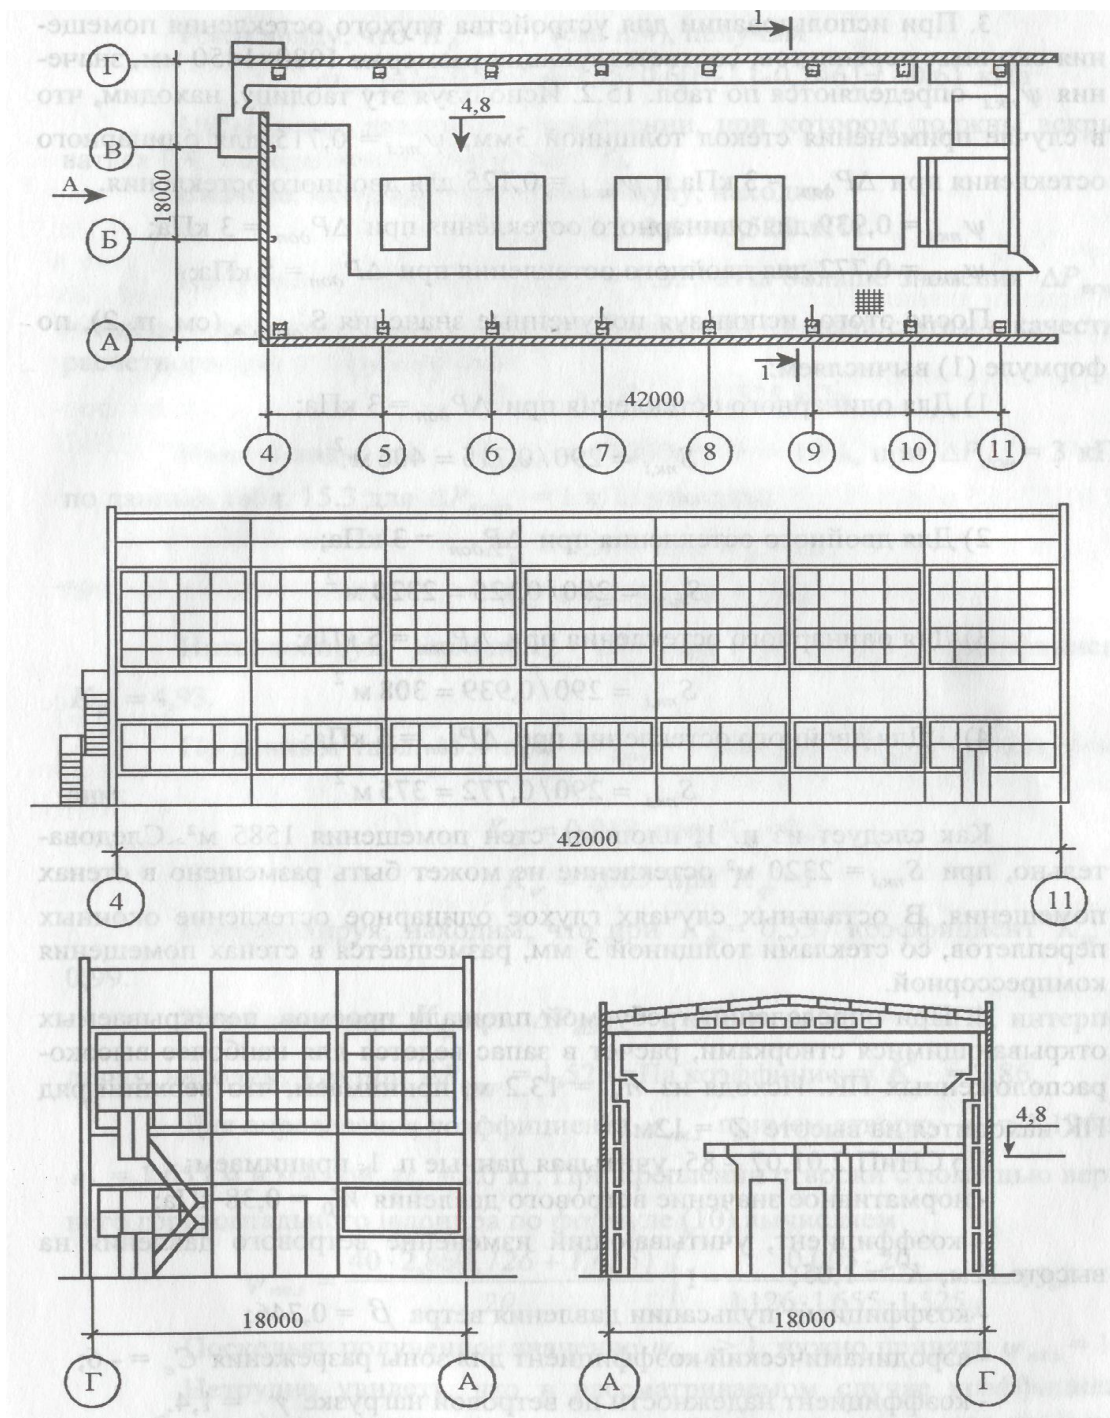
План здания в - вид здания компрессорного отделения: а - главный фасад; б - здания по стрелке А; г - поперечное сечение здания 1-1
